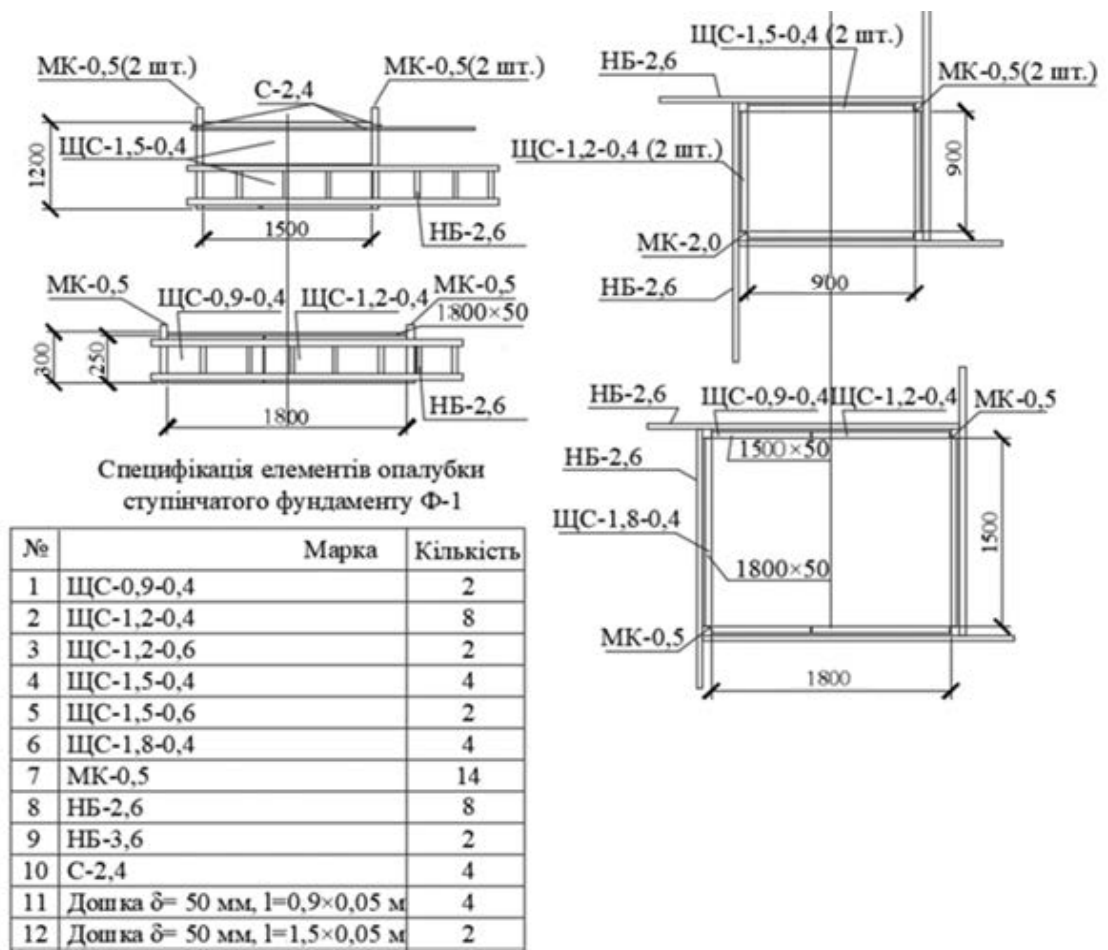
(2) Маркувальна схема ступінчастого фундаменту зі специфікацією елементів опалубки
